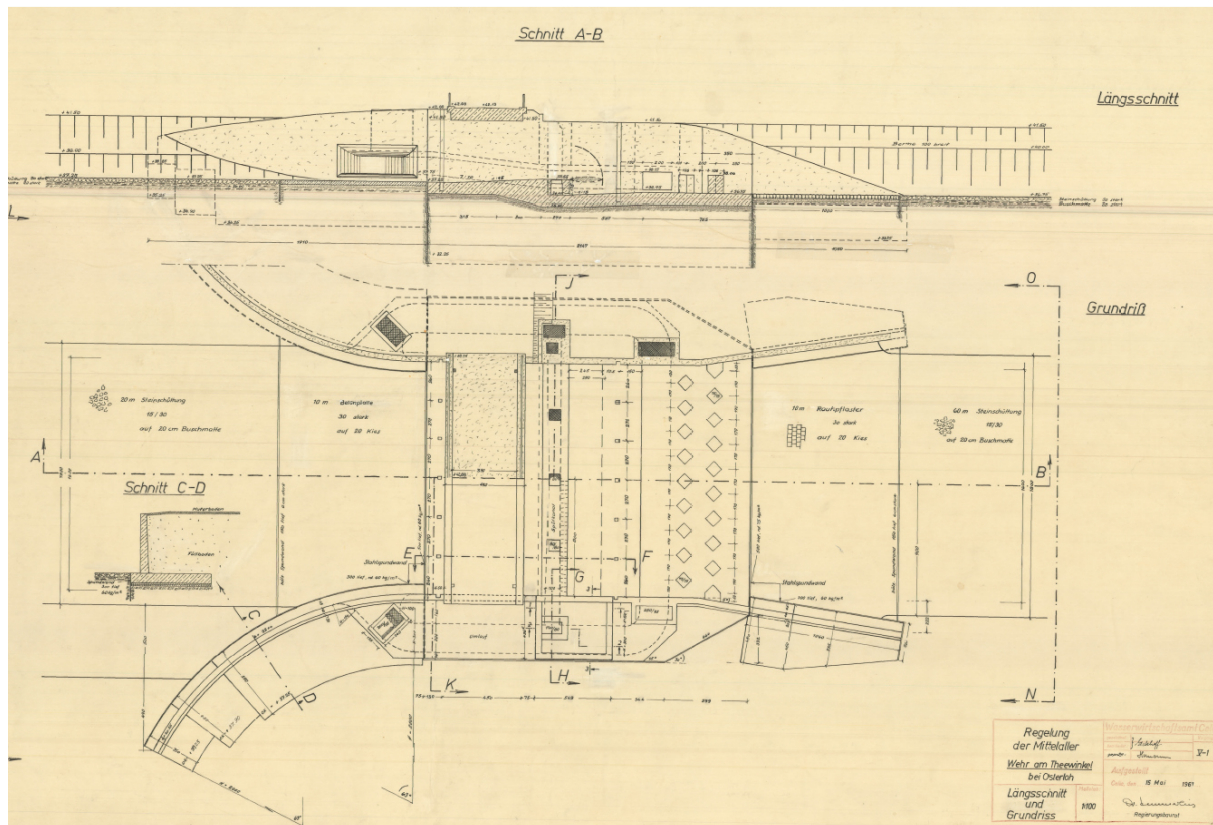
Wehr, Grundriss und Längsschnitt
